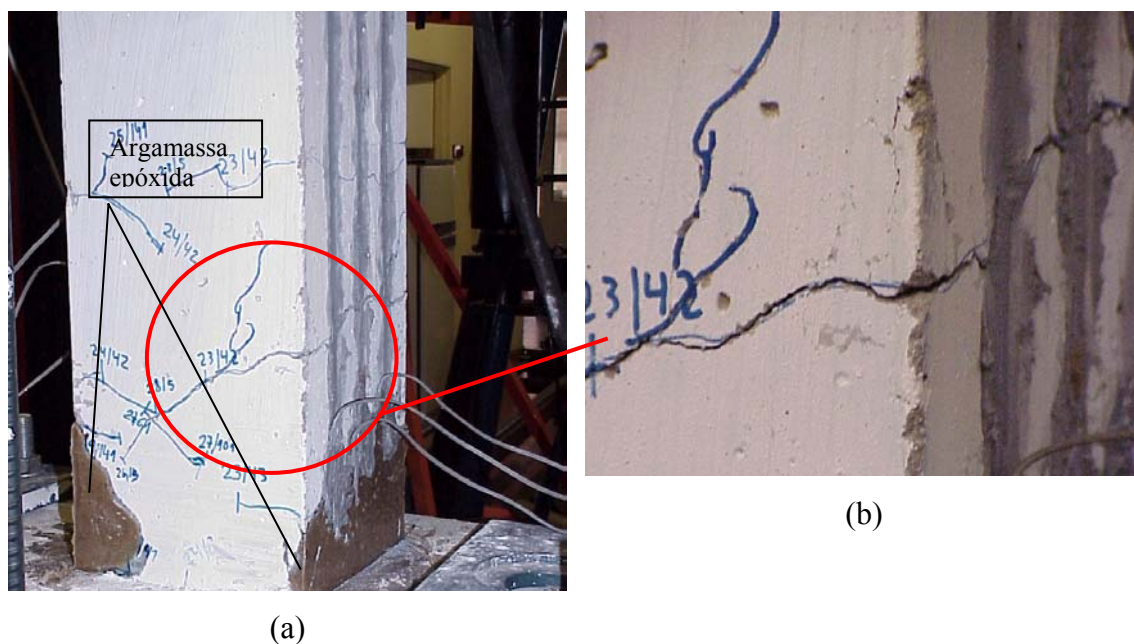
Fissuras existentes no P16aCR após a aplicação do reforço; (a) aspecto do P16aCR antes de ser ensaiado pela 2ª vez; (b) pormenor das fissuras que não foi selada.
